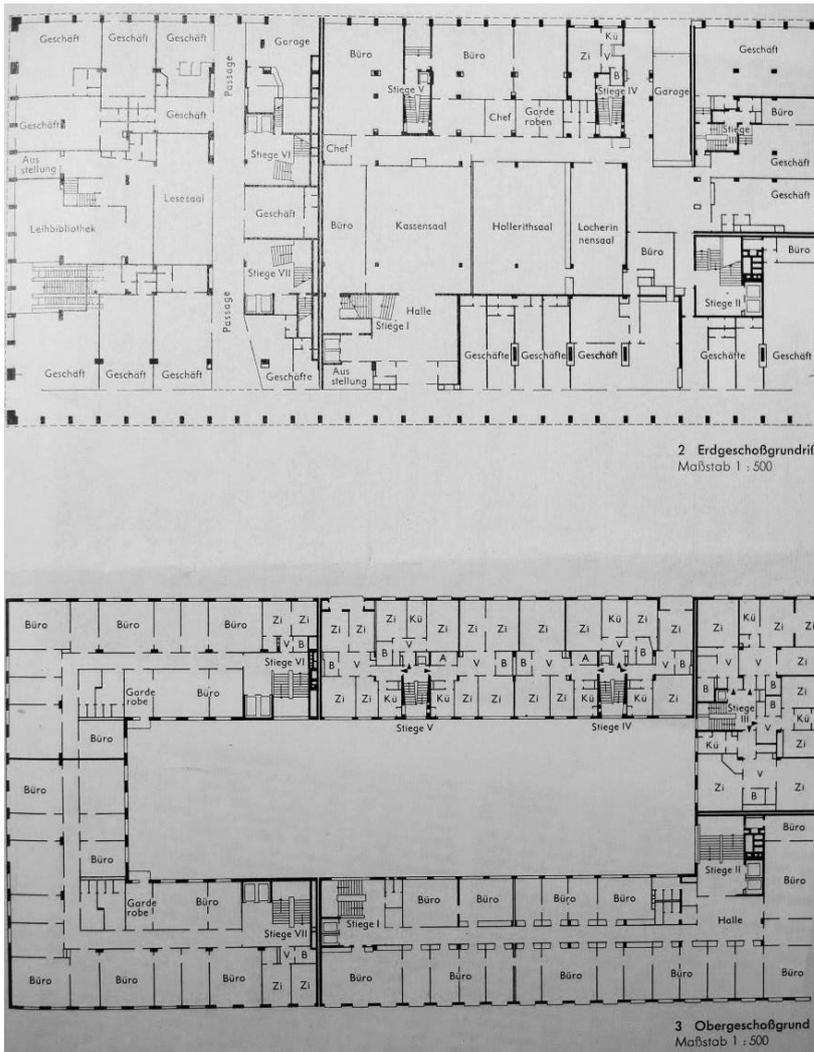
Opernringhof, Grundrisse Erdgeschoß und Obergeschoß, 1956
